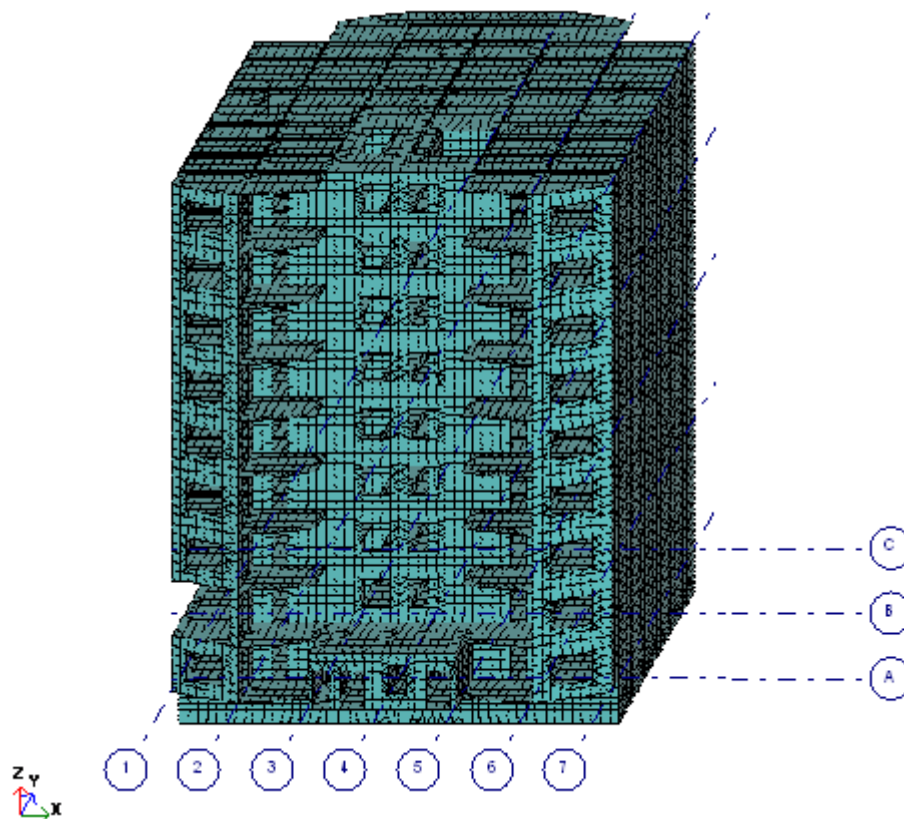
Расчетная схема здания для 1-го случая локального разрушения
